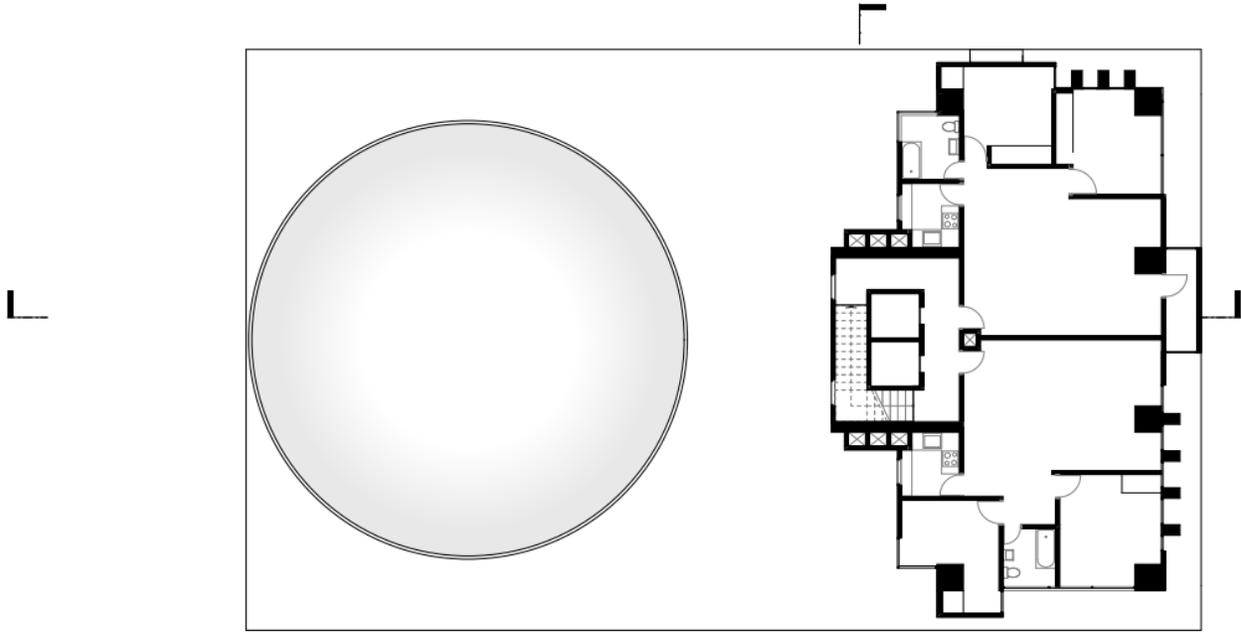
Planta alta planificada N+27.50. Fuente: Tesistas.
